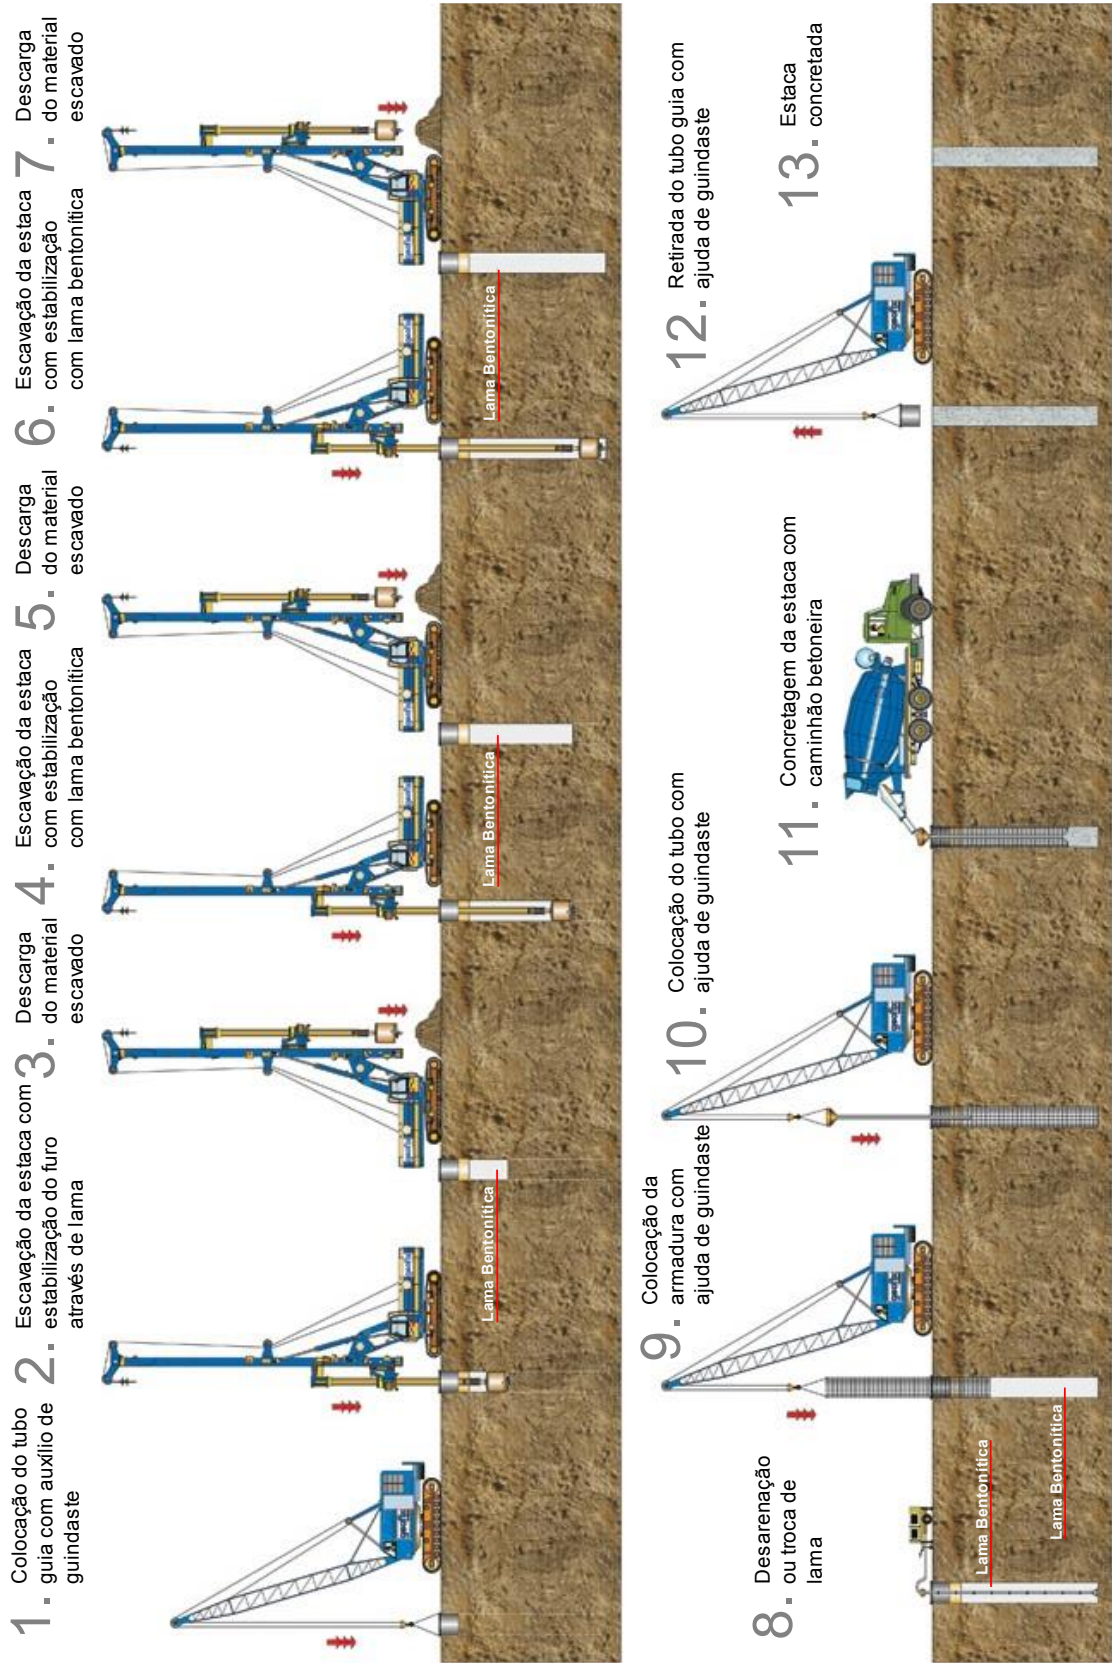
Etapas de Construção de Estacas Escavadas (adaptado de <<http://bit.ly/construcao-estaca-escavada>>)
